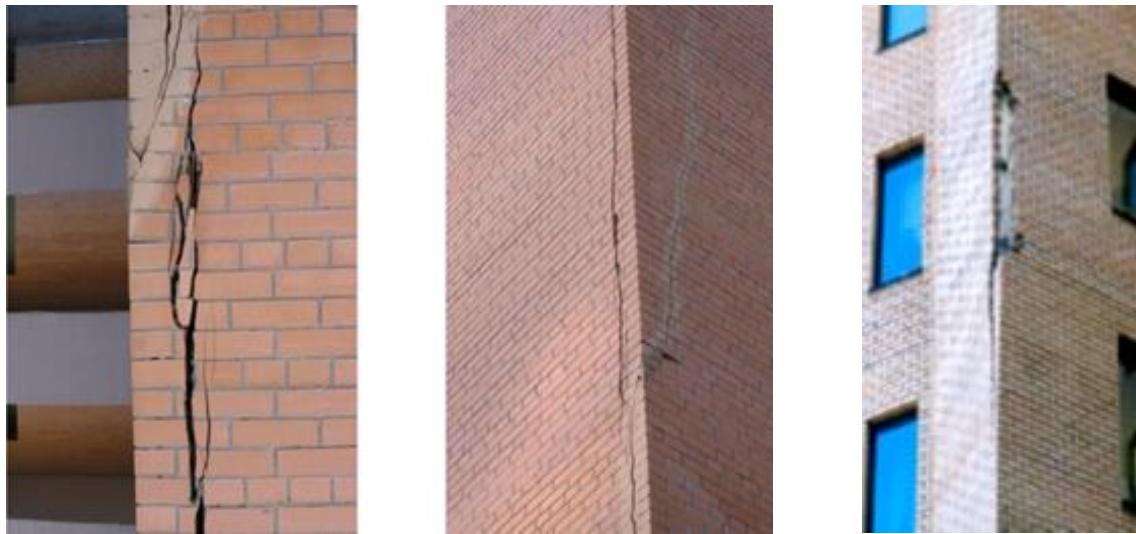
Образование вертикальных и/или наклонных трещин в угловых зонах из-за отсутствия или недостаточного их армирования, отсутствия вертикальных деформационных швов
